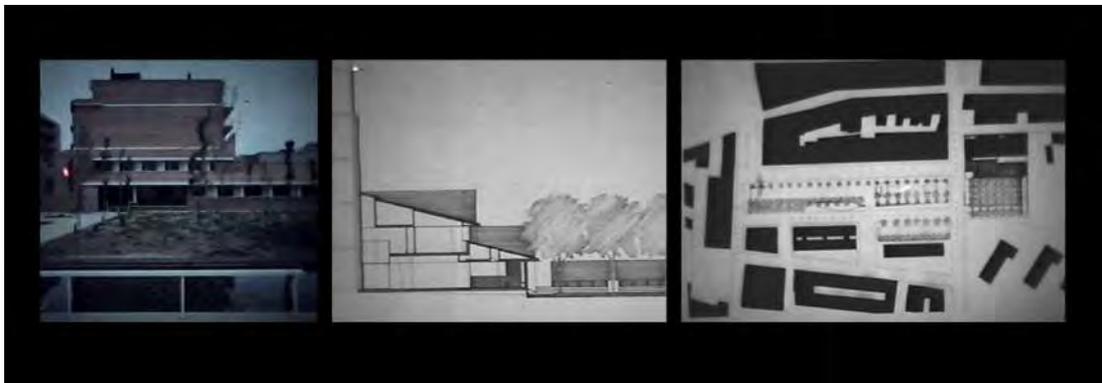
Pep Llinás, Biblioteca de Vila-Seca en Terragona. Fotografía, corte y planta de implantación.
